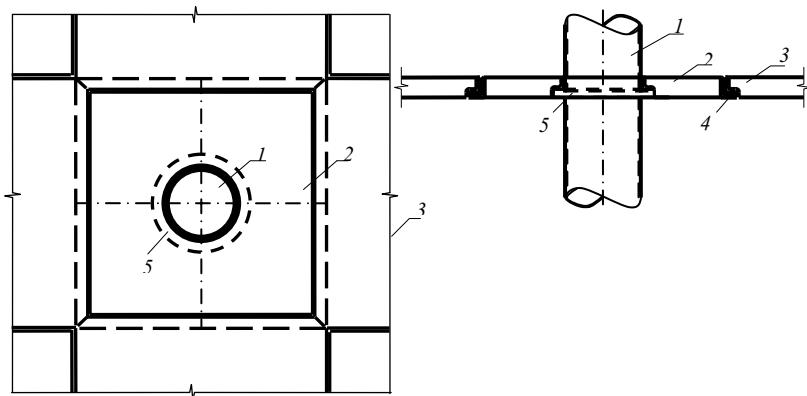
Фрагмент збірного сталезалізобетонного безбалкового перекриття:
